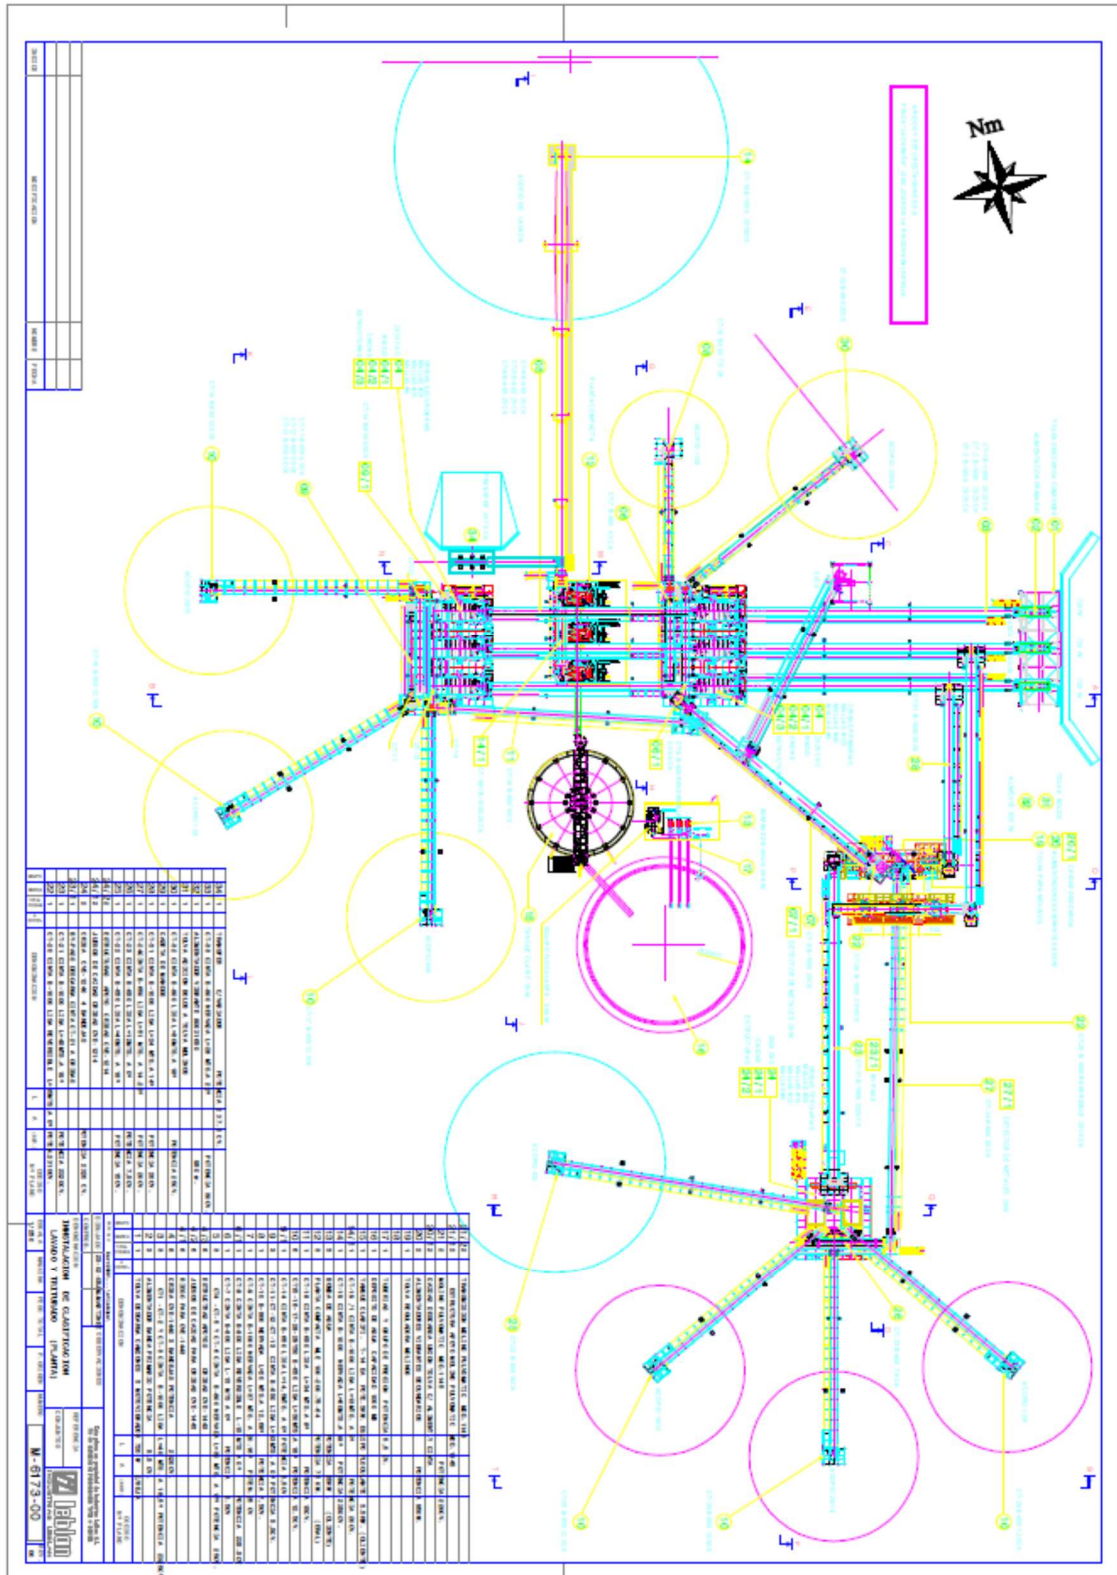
Plano croquis planta de tratamiento de áridos (vista planta), con posiciones de elementos
